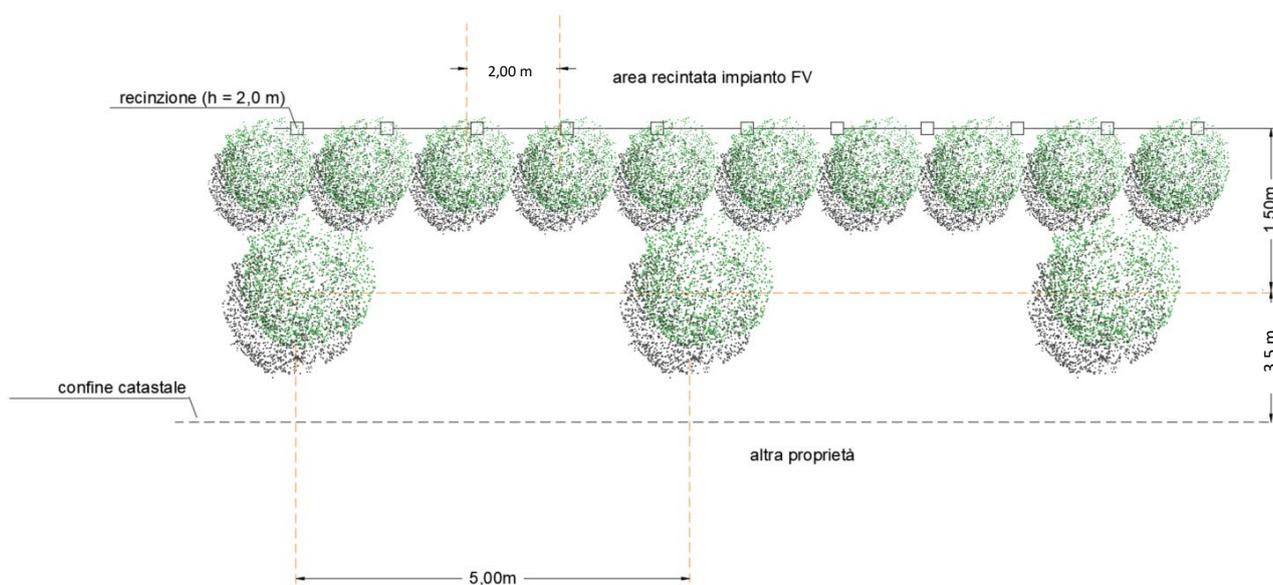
Siepe polispecifica (planimetria di progetto).
